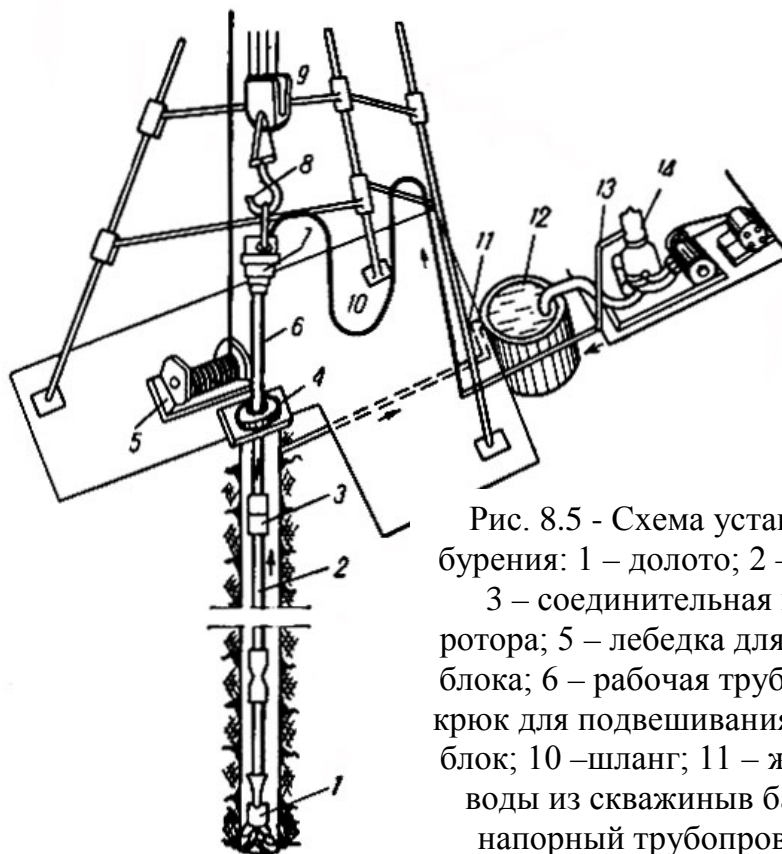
Схема установки роторного бурения: 1 – долото; 2 – бурильная труба; 3 – соединительная муфта; 4 – стол ротора; 5 – лебедка для подъема талевого блока; 6 – рабочая труба; 7 – вертлюг; 8 – крюк для подвешивания труб; 9 – талевый блок; 10 – шланг; 11 – желоб для возврата воды из скважины в бак; 12 – бак; 13 – напорный трубопровод; 14 – насос с двигателем для подачи в скважину
